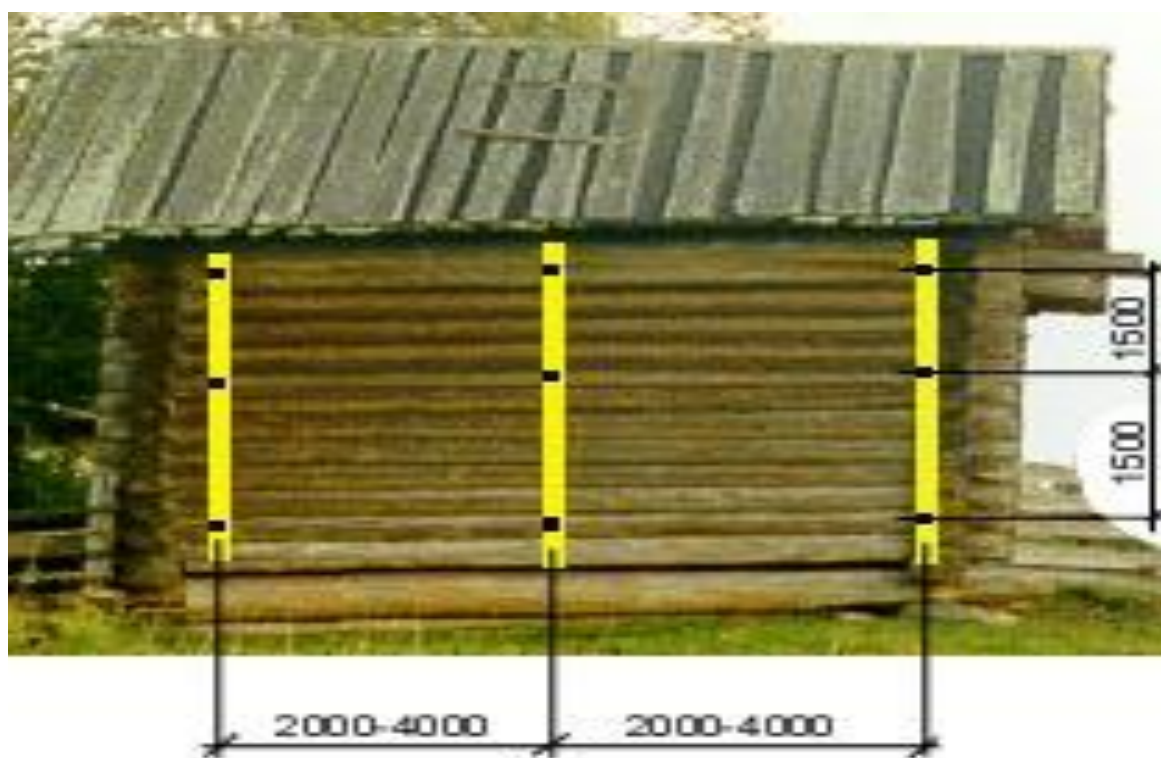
Усиление бревенчатых стен вертикальными сжимами
